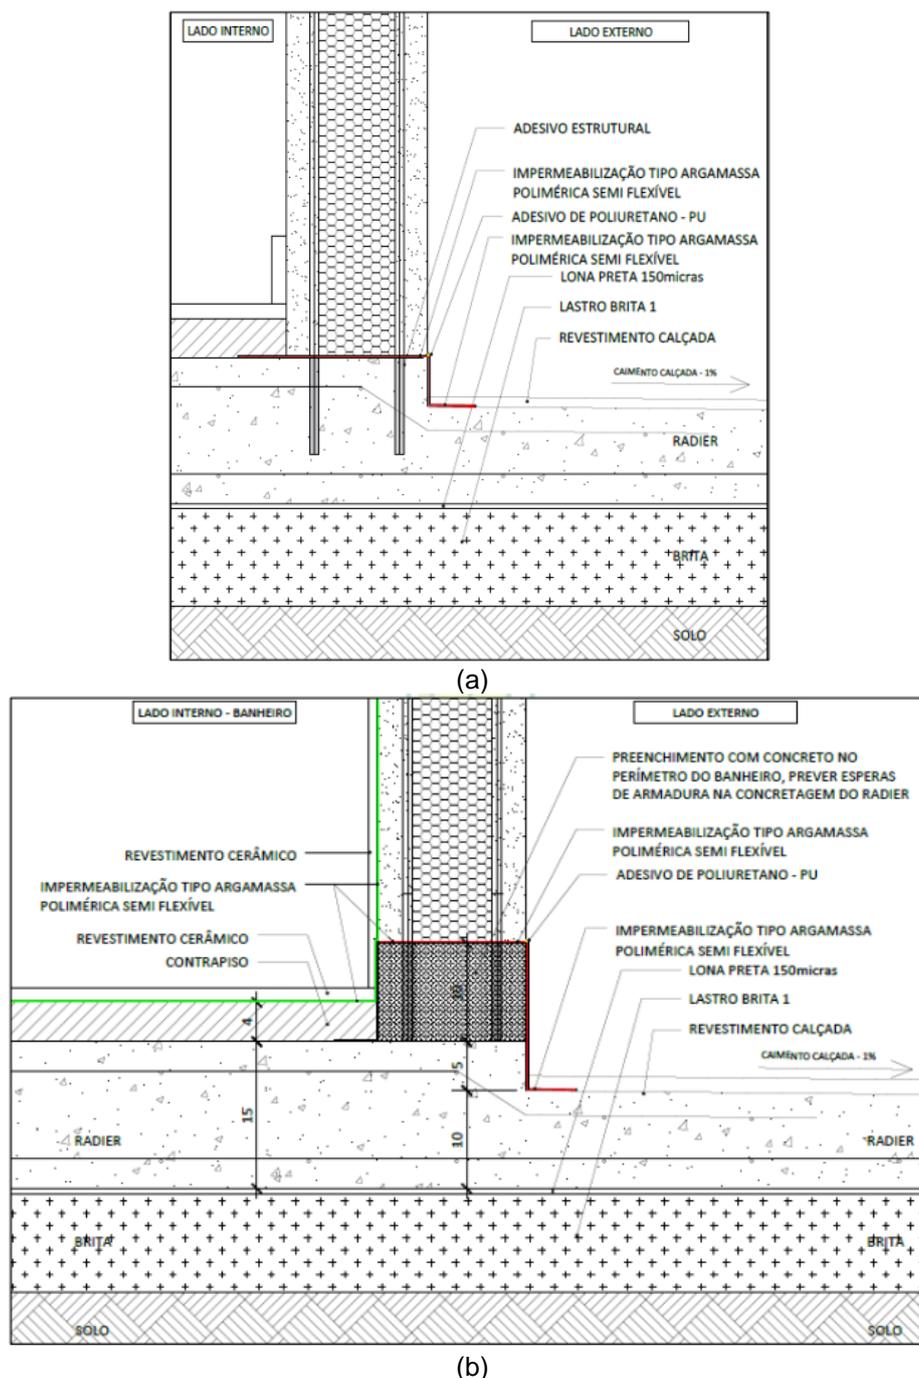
Detalhe da impermeabilização: (a) base da vedação vertical e fundação, (b) base da vedação vertical e fundação em áreas molhadas
